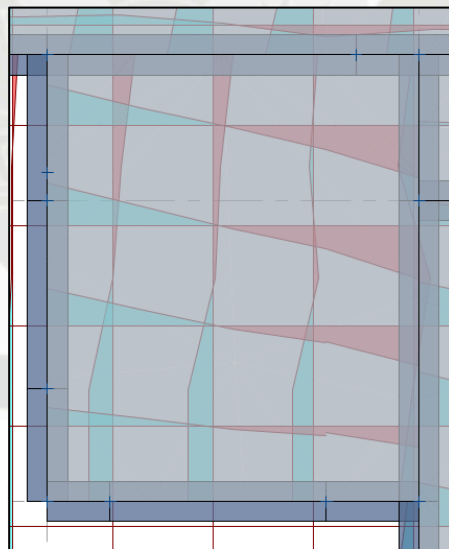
Fuerzas cortantes por metro de ancho en losas de cimentación.
